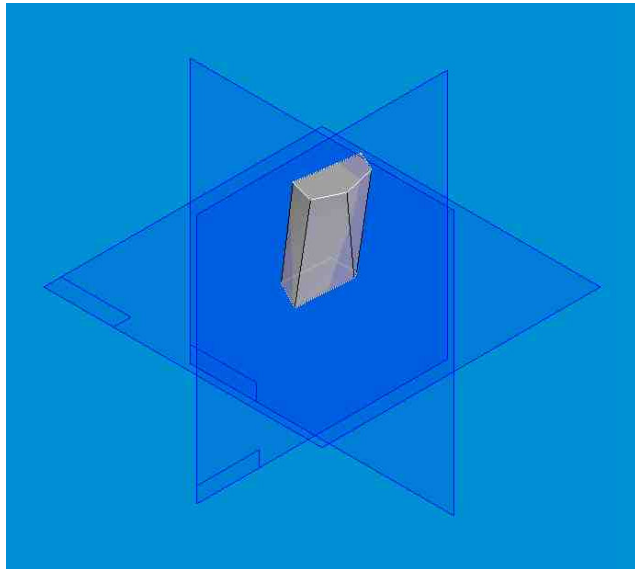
Ricostruzione geometrica del pilastro 22.
